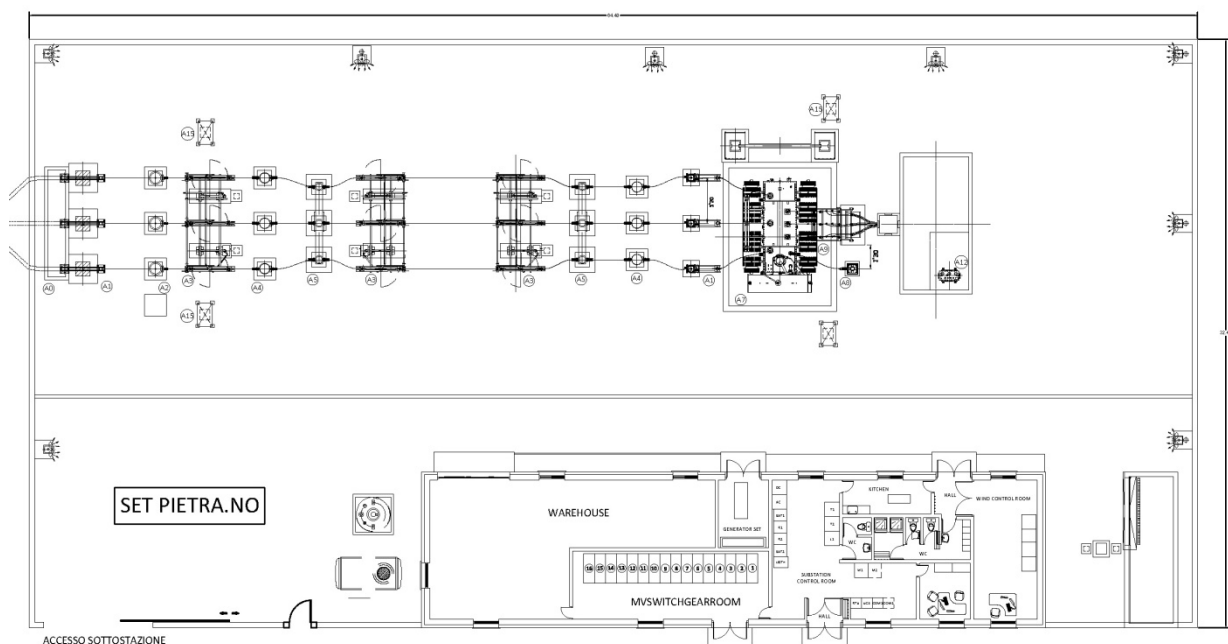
Planimetria Stazione Elettrica Utente Condivisa
